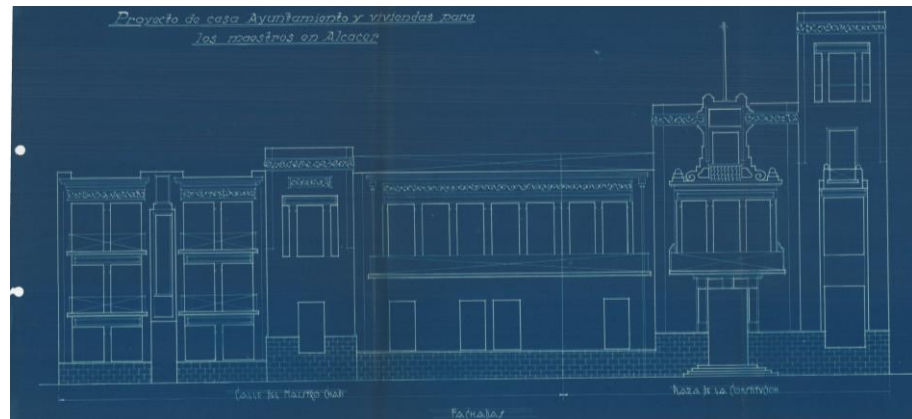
Alzados del proyecto de Rieta del Ayuntamiento de Alcácer
